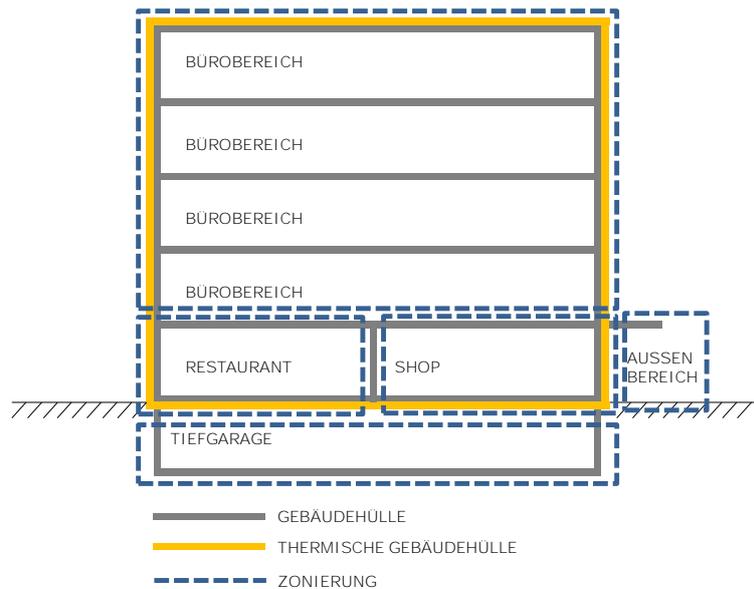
Beispielgebäude mit Zonierung Gebäudezone
